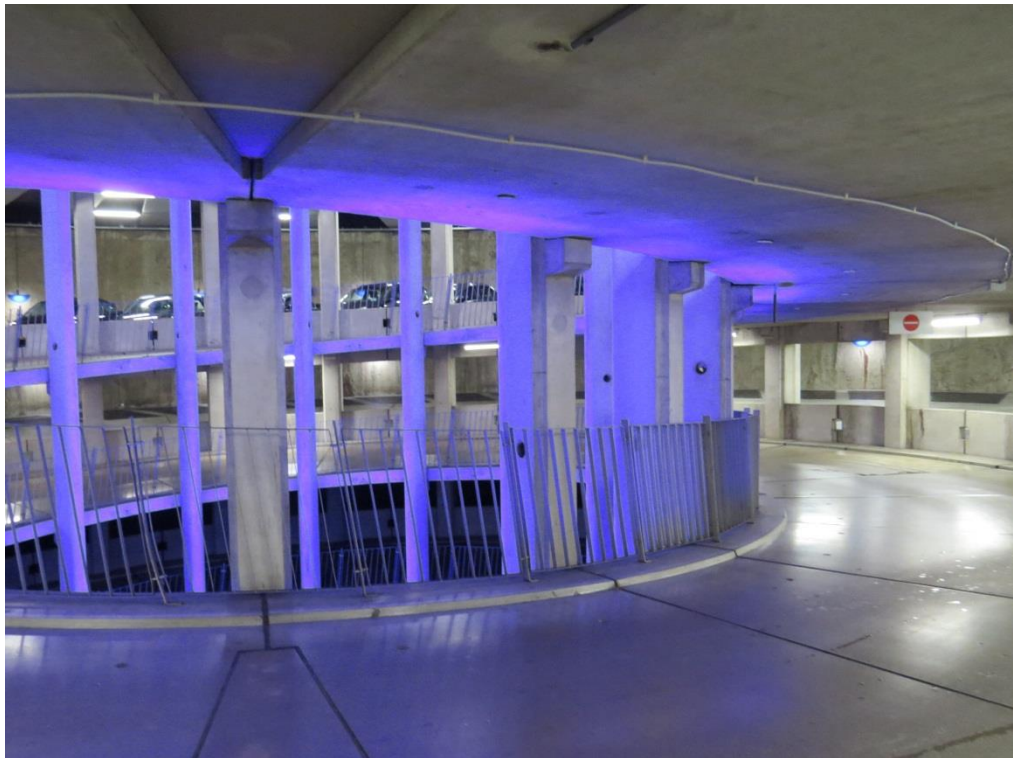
Binnenring opgebouwd uit puntvormig opgelegde prefab platen op nokken aan de kolommen.
